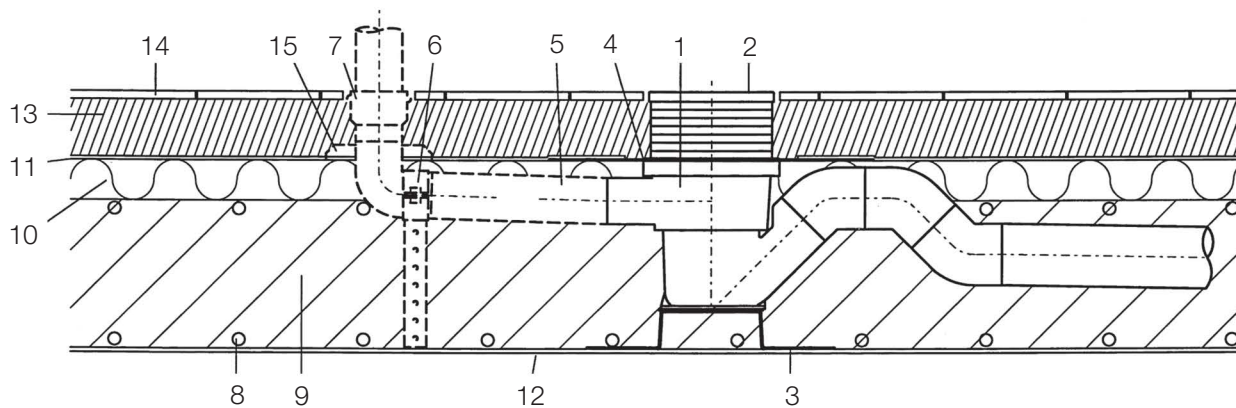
Einbau mit Anschlussblech, Boden Plattenbelag
